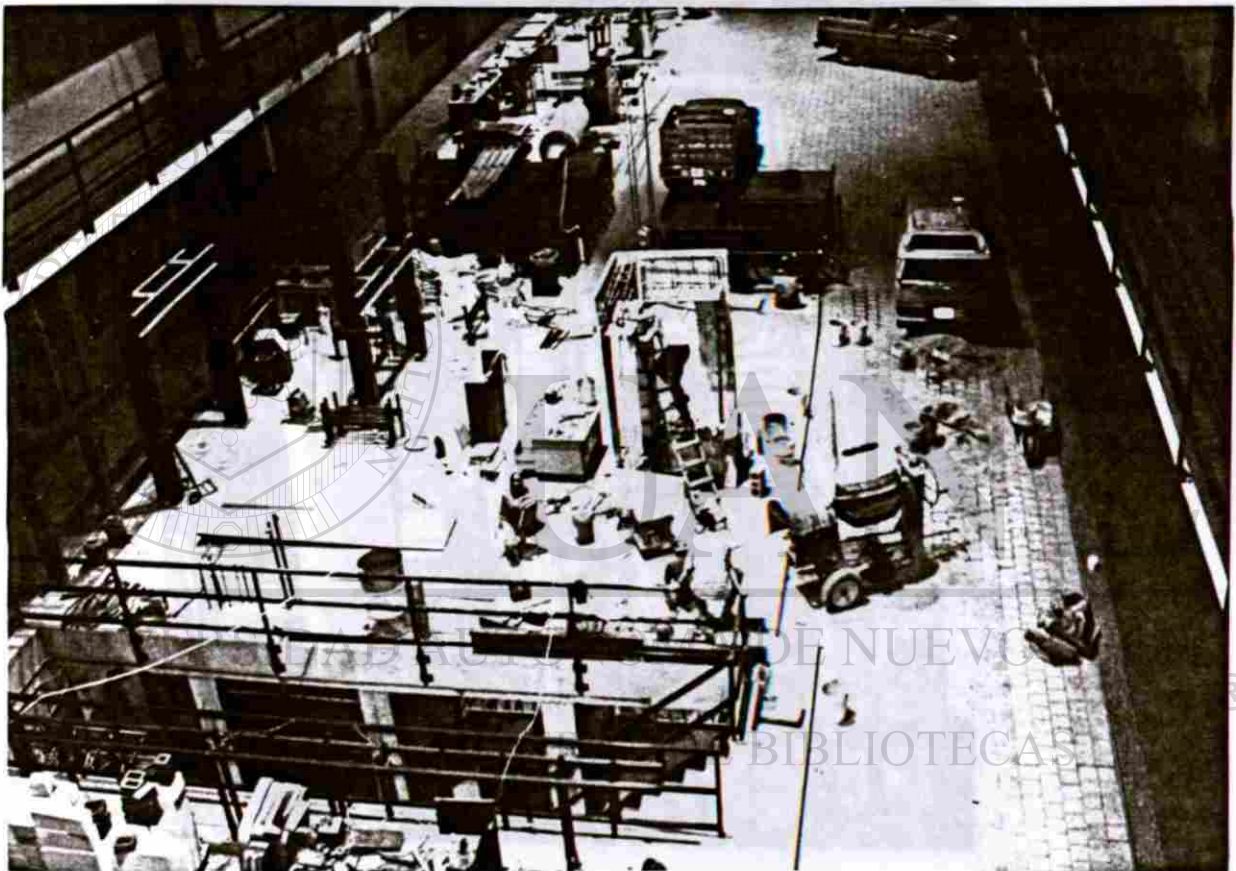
Se muestra la cimbra metálica utilizada, aquí se le coloca un desencofrante.
